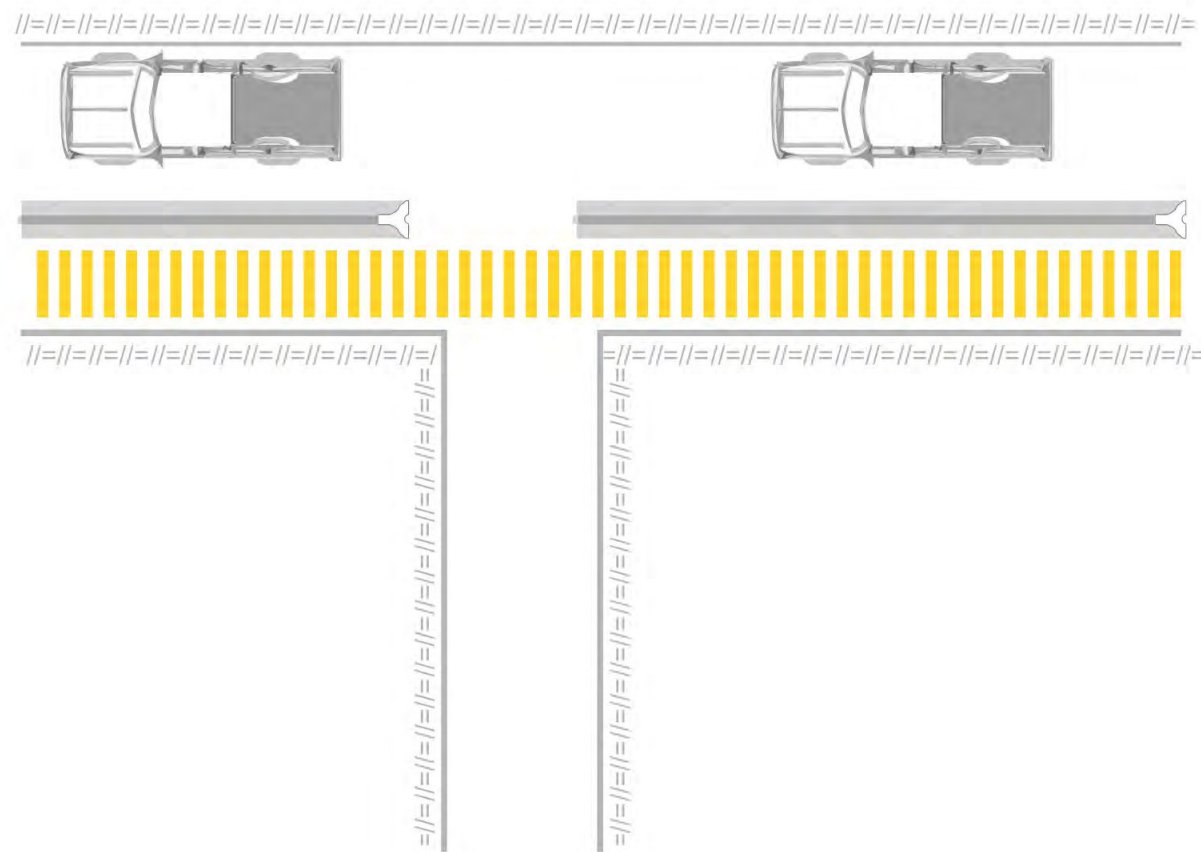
Planta de segregación tipo con barrera New Jersey, vía peatonal y vehicular.
